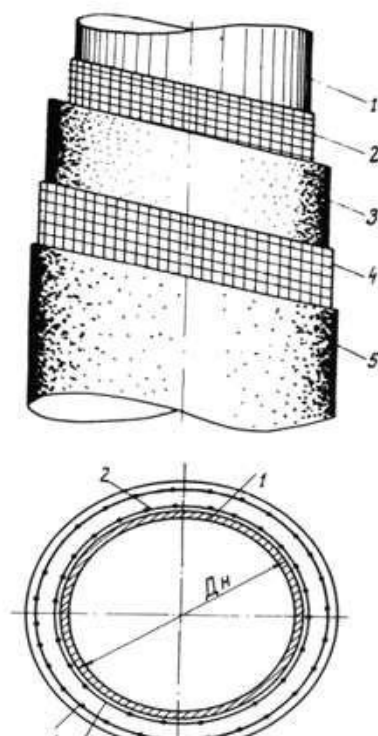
Конструкция монолитного бетонного покрытия:
